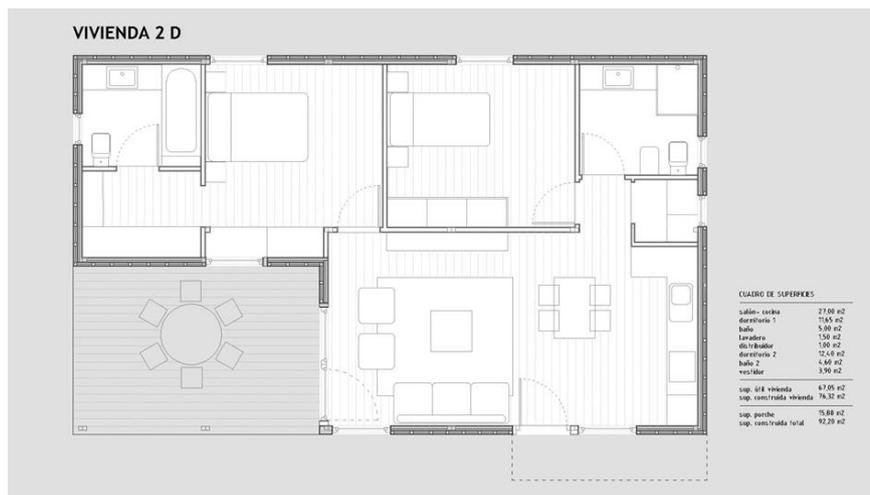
Plano vivienda modular 2 dormitorios, Empresa HOME3
